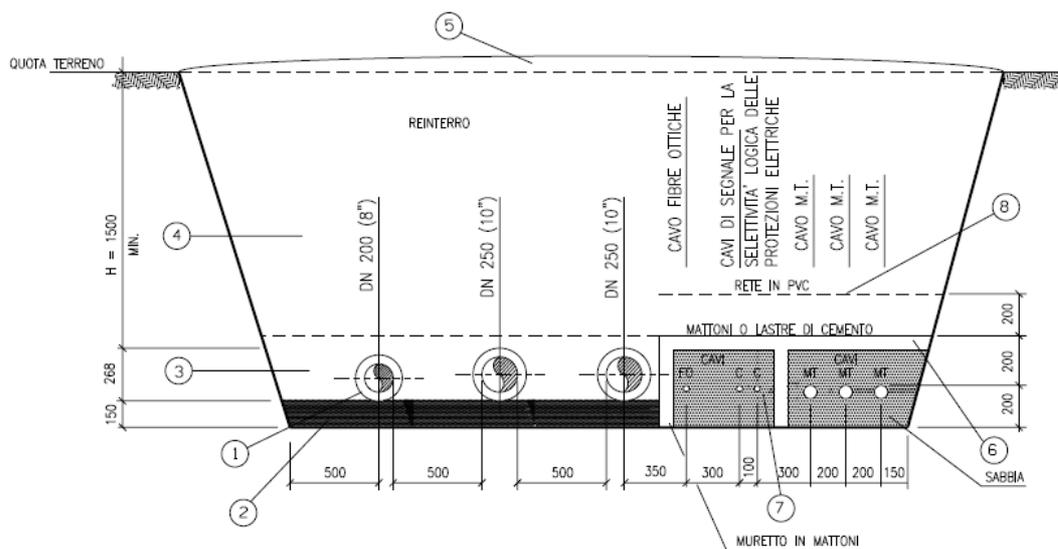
sezione tipo di scavo (Fonte: Standard di progetto – Progetto Pergola 1, eni – emissione finale 27 Giugno 2013)
